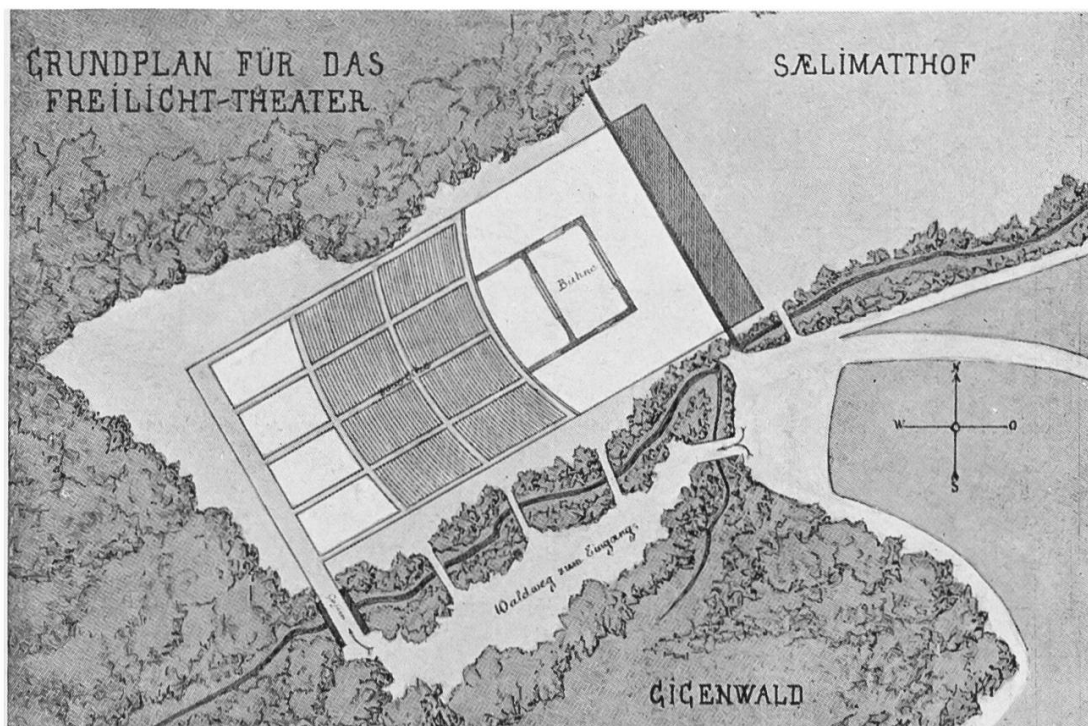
Freilichttheater Luzern. Grundriss.
